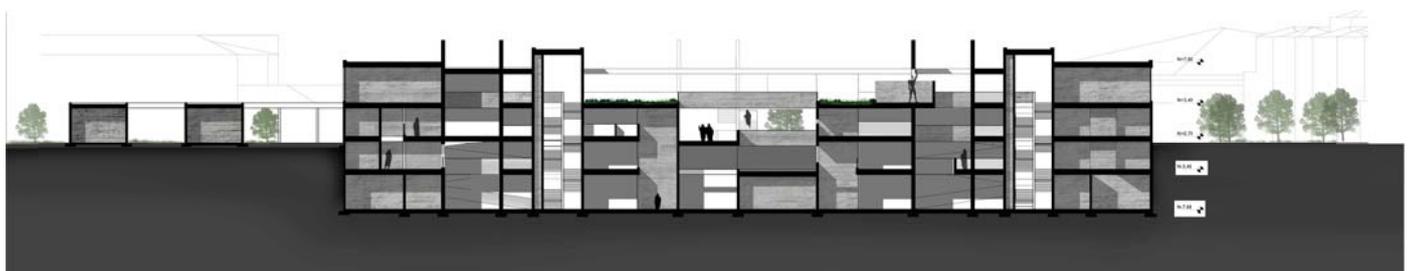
Corte por Fachada. Fuente: Elaborado por el autor
